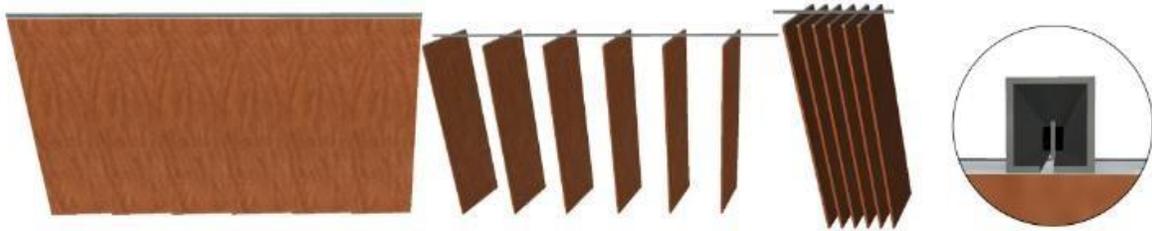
Paneles plegables (Fuente: Alejandra durán)
